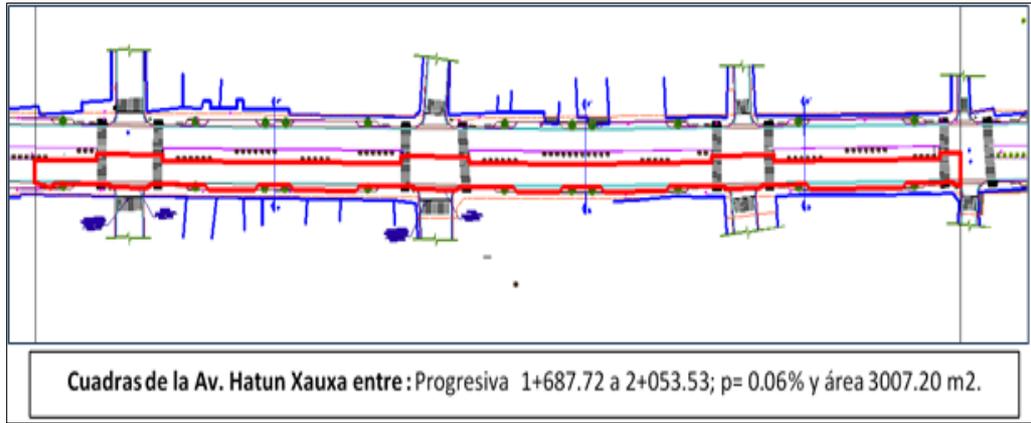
Seccionamiento de la Av. Hatun Xauxa
